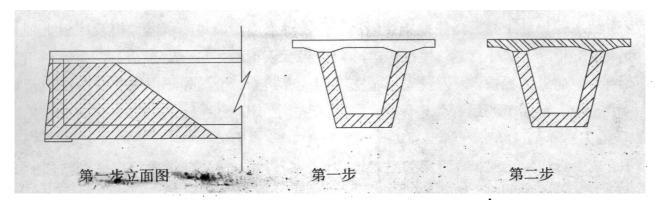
混凝土浇筑顺序 Fig. 2-12 Concrete pouring sequence
